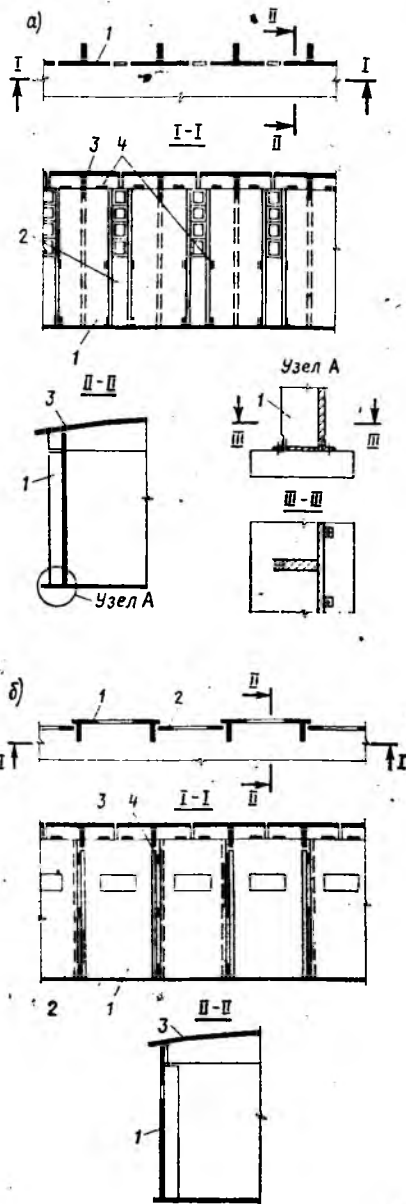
Схема экспериментального здания из Т-образных панелей перекрытия и стеновых панелей различной конструкции
